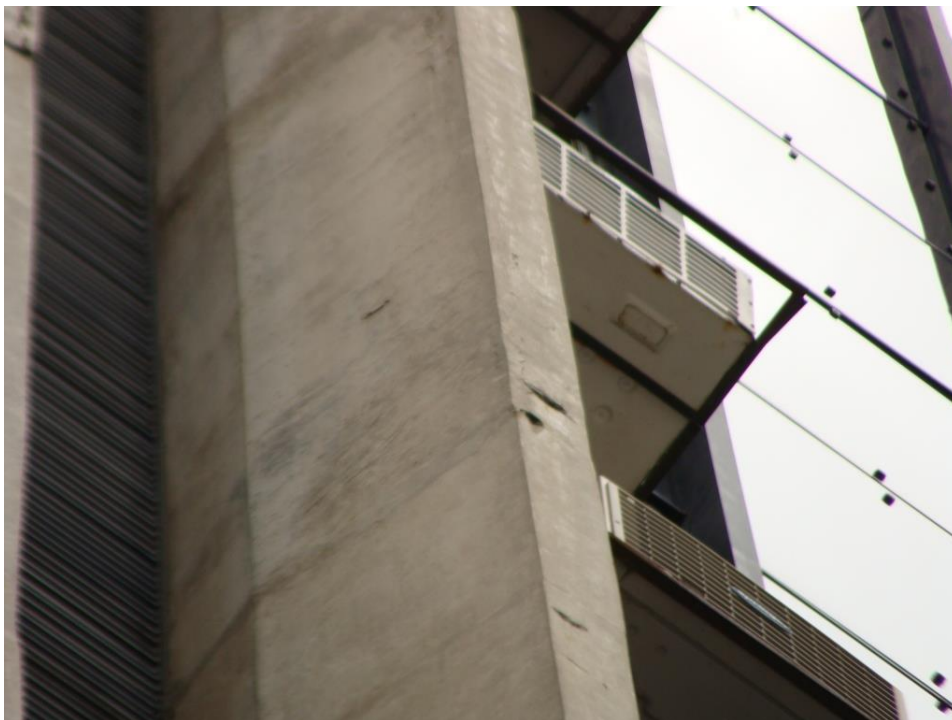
Armadura exposta pilar P12 (5º pavimento) (02/03/2021)
